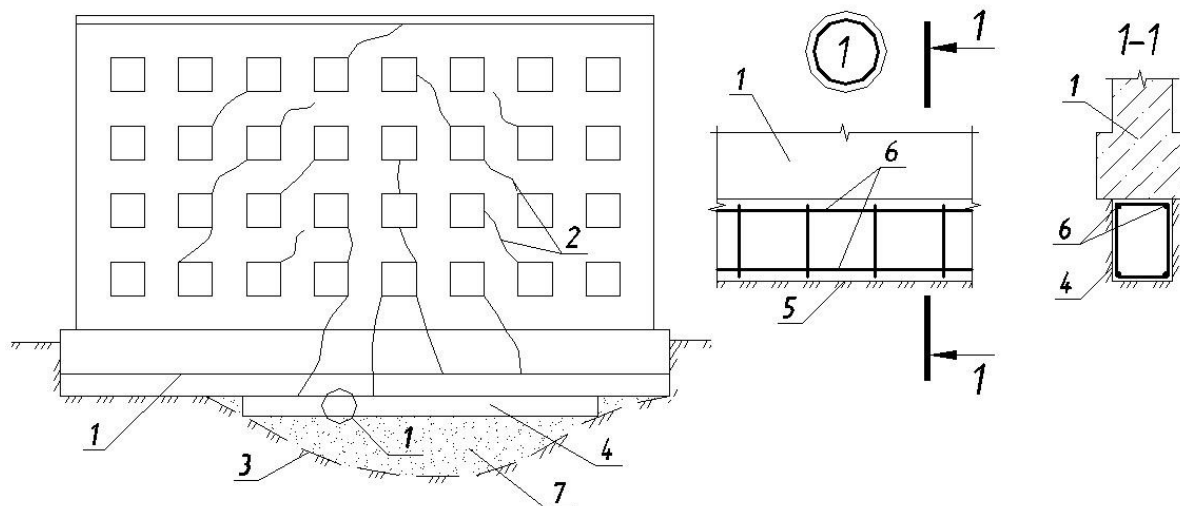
Розвантаження ослабленої частини фундаменту улаштуванням в основі залізобетонної балки: 1 – посилюваний фундамент; 2 – тріщини в стінах; 3 – контур осадової вирви;
